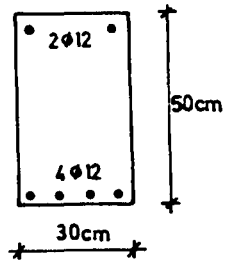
Kolon ve kiriş donatılarının işlenmesi
